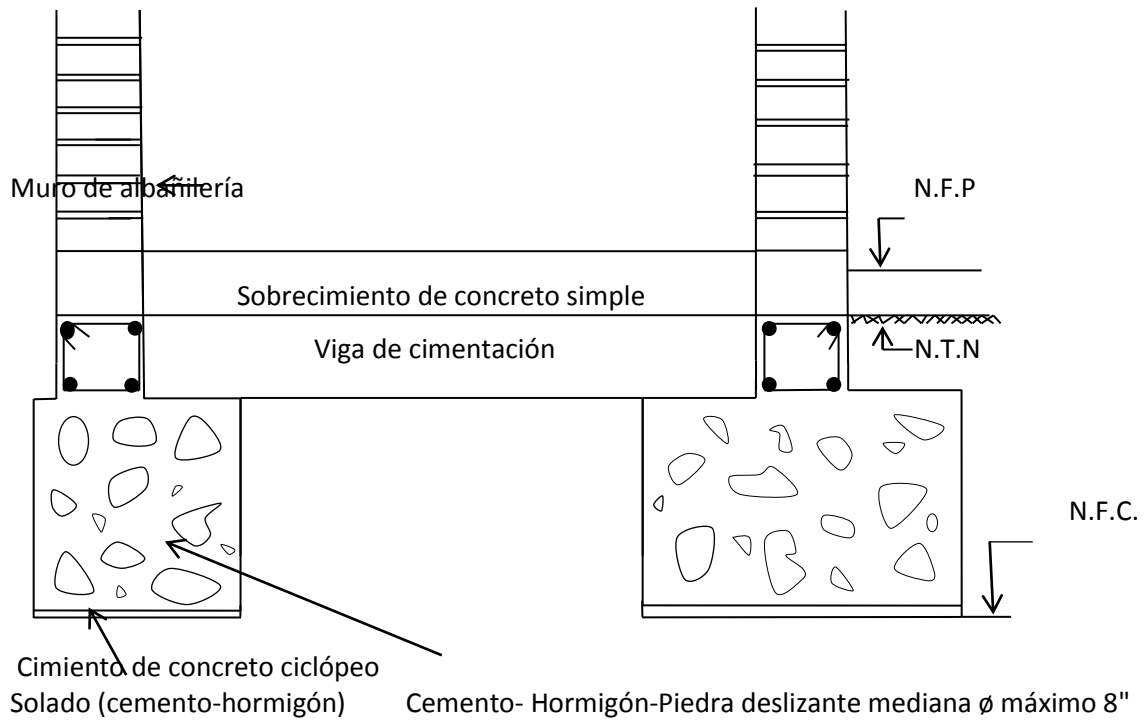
Construcción típica del cimiento (zapatas aisladas) de las viviendas en la zona de Mollepampa- Cajamarca.
